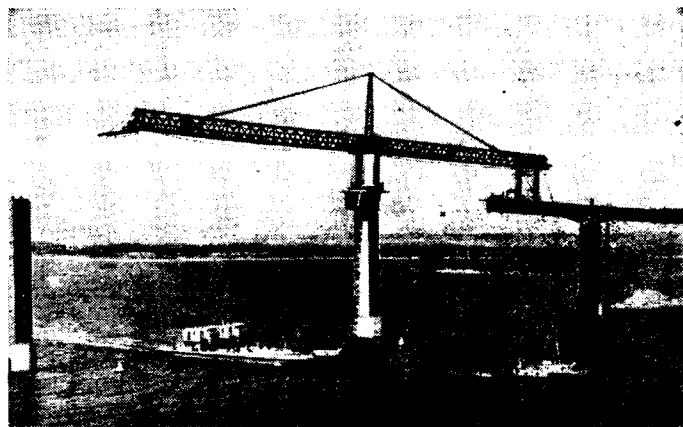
Кран МСШК-2×50 на строительстве моста через р. Дон у г. Калача
